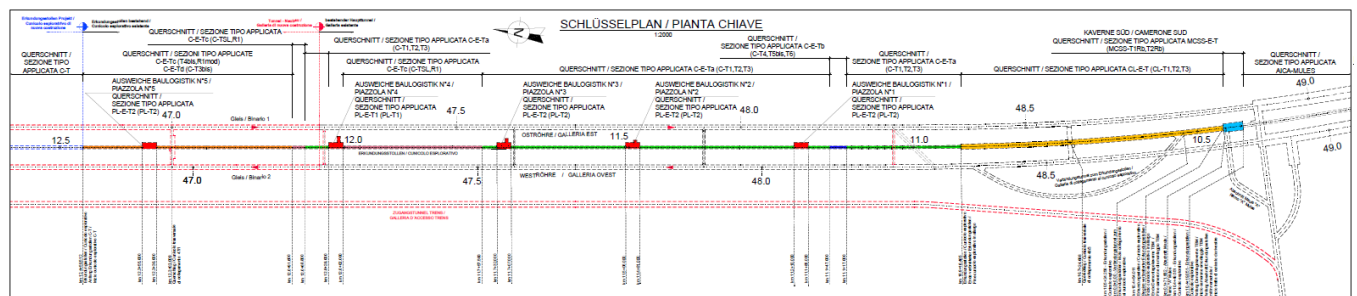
Planimetrisches Schema der bestehenden Erkundungsstollenstrecke.
